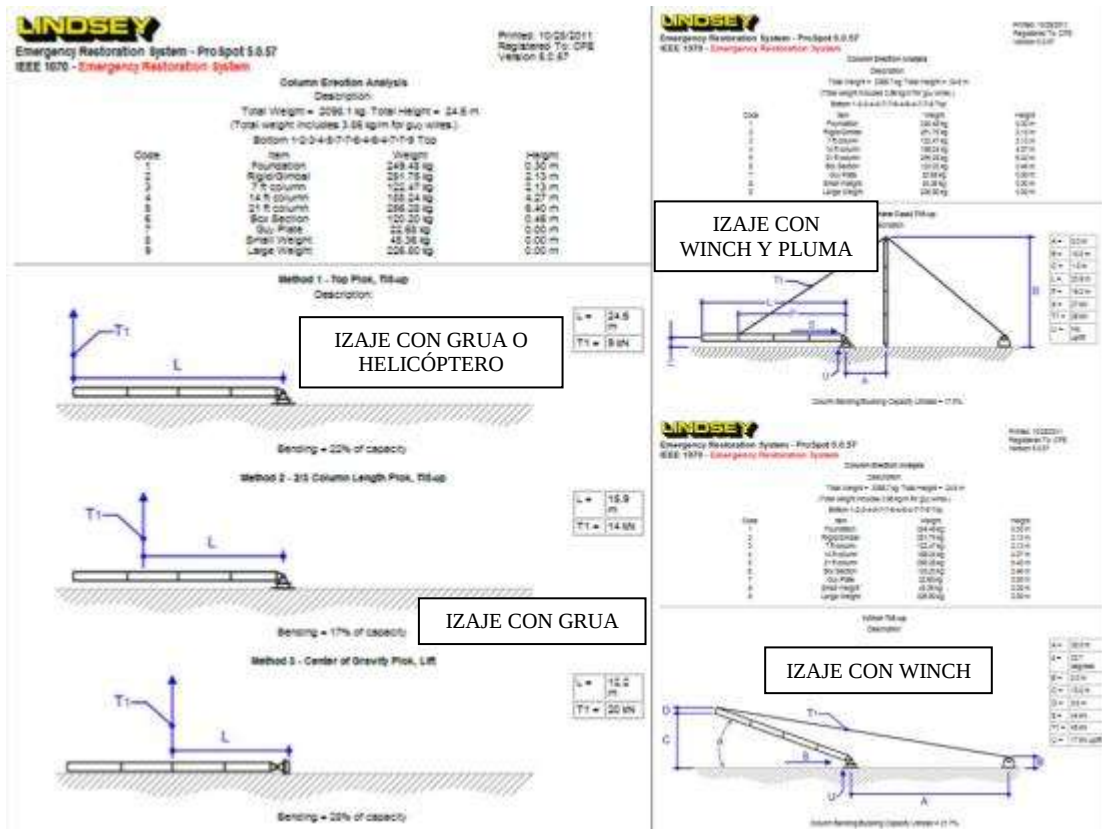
Análisis de izaje de las estructura modulares de emergencia.
